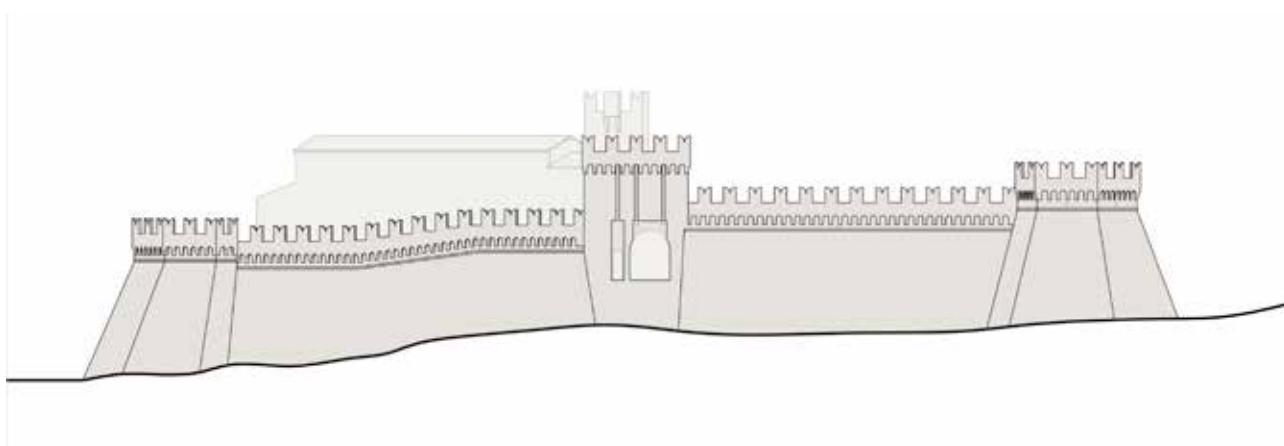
Ipotesi di ricostruzione del prospetto Sud-Est nel XVI secolo
